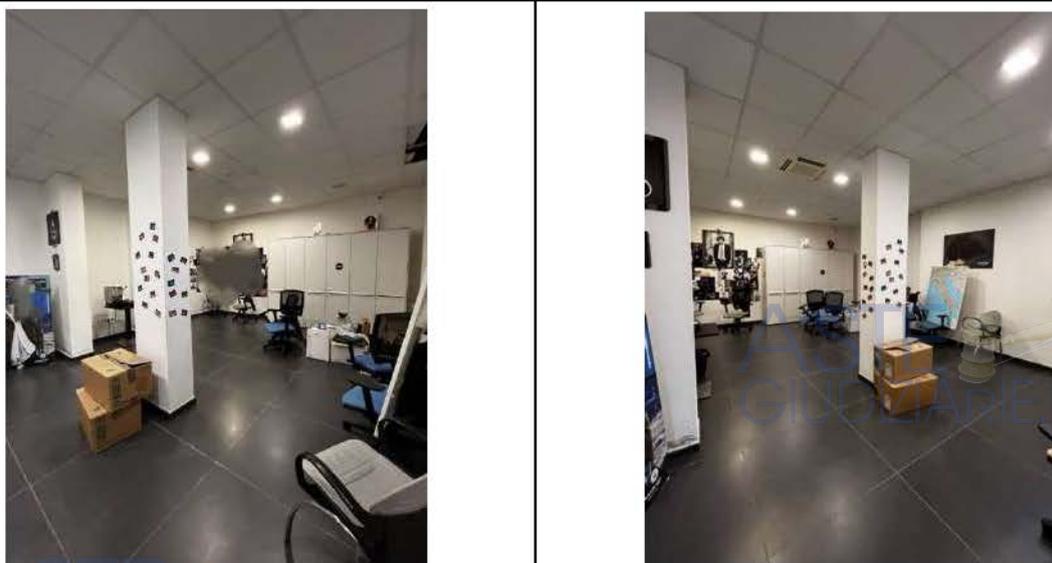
Uffici posti sul lato nord ovest e con affaccio sulla corte interna posto al piano seminterrato Sub. 1
